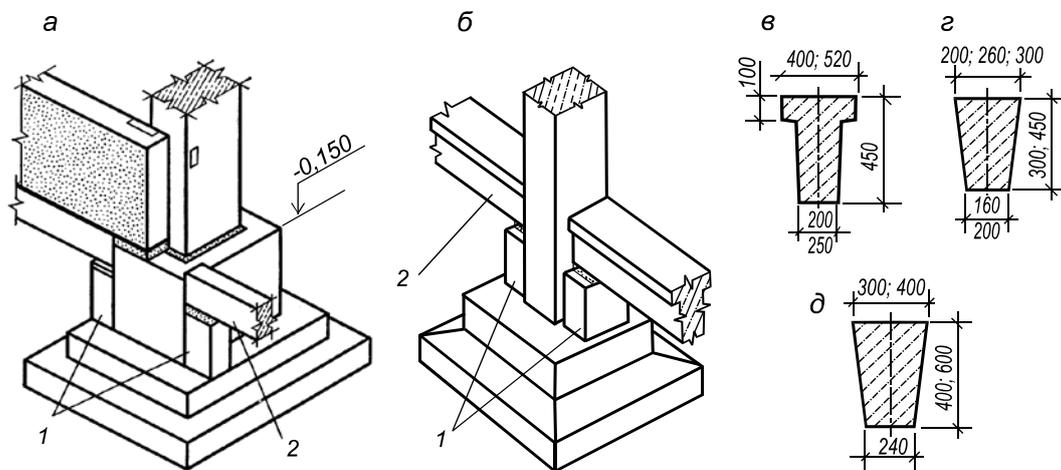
Фундаментные балки: *а, б* — опирание на фундамент балок крайнего (*а*) и среднего (*б*) ряда; *в, г* — сечение балок при шаге колонн 6 м; *д* — то же при шаге 12 м; *1* — железобетонные столбики; *2* — фундаментная балка
